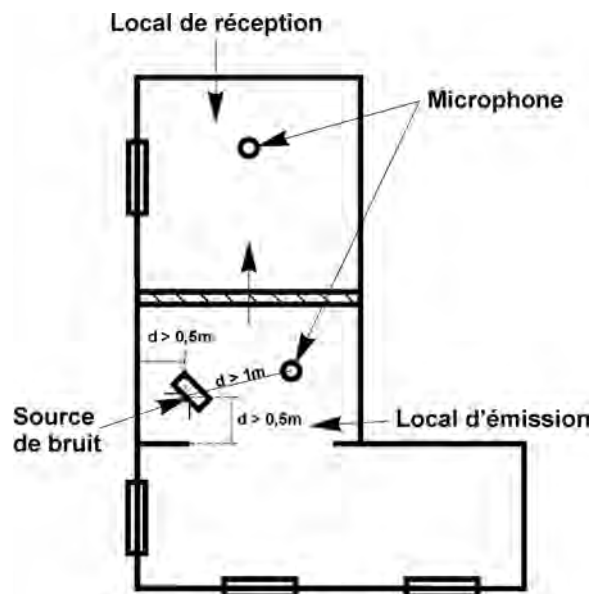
Mesurage de l'isolement horizontal entre locaux - Cas de locaux séparés par une baie libre (par exemple, cas d'une cuisine ouverte sur la pièce principale).
